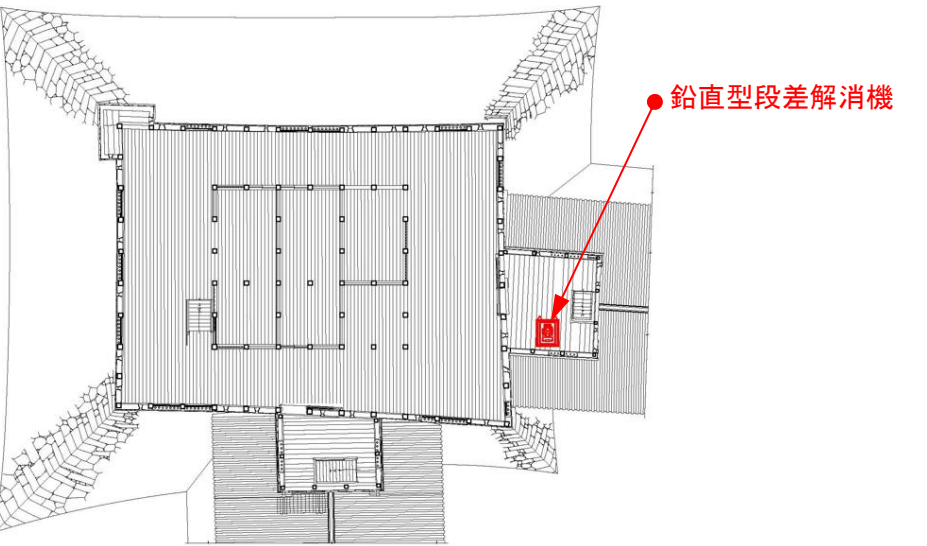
天守 1 階平面図及び東廊下・南廊下 2 階平面図（復元原案）
